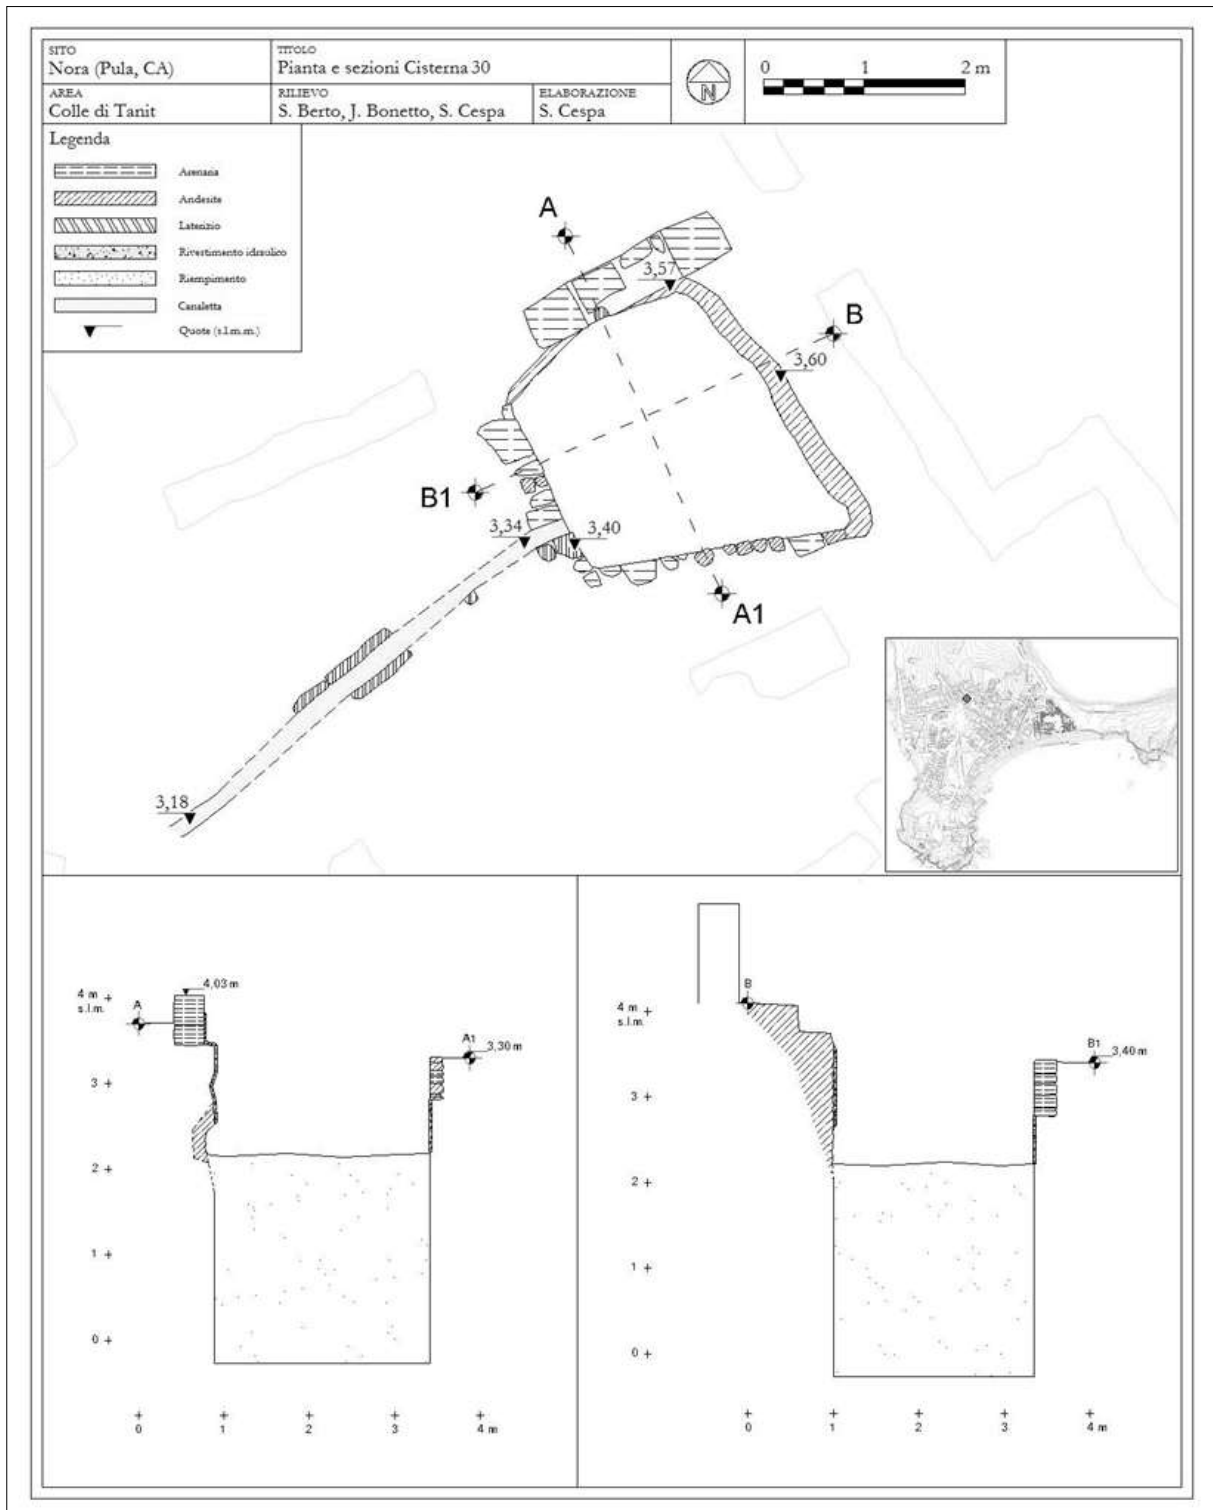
Pianta e sezioni della cisterna 30 (elaborazione dell'autore).
